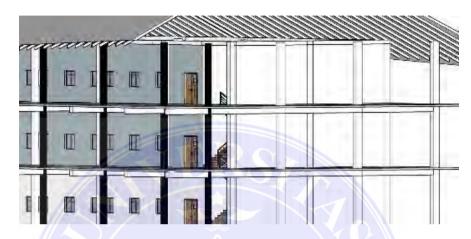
19 Konsep Struktur Pondasi Bangunan
